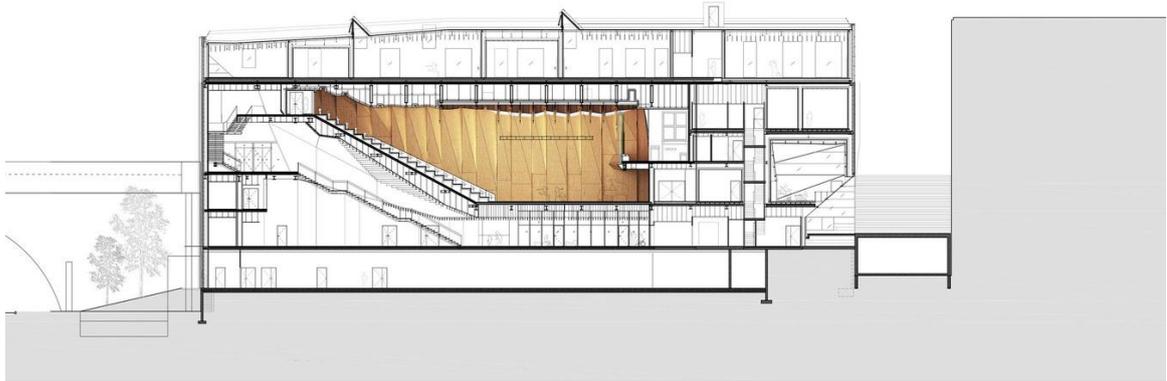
Corte Longitudinal da lâmina Leste/Oeste (FONTE: Archidaily, 2014).
